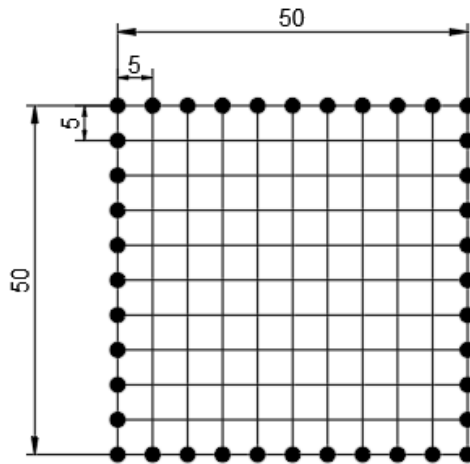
Configuração atualizada da rede de aterramento com mais condutores horizontais e elétrodos verticais. Comprimentos em metros.
